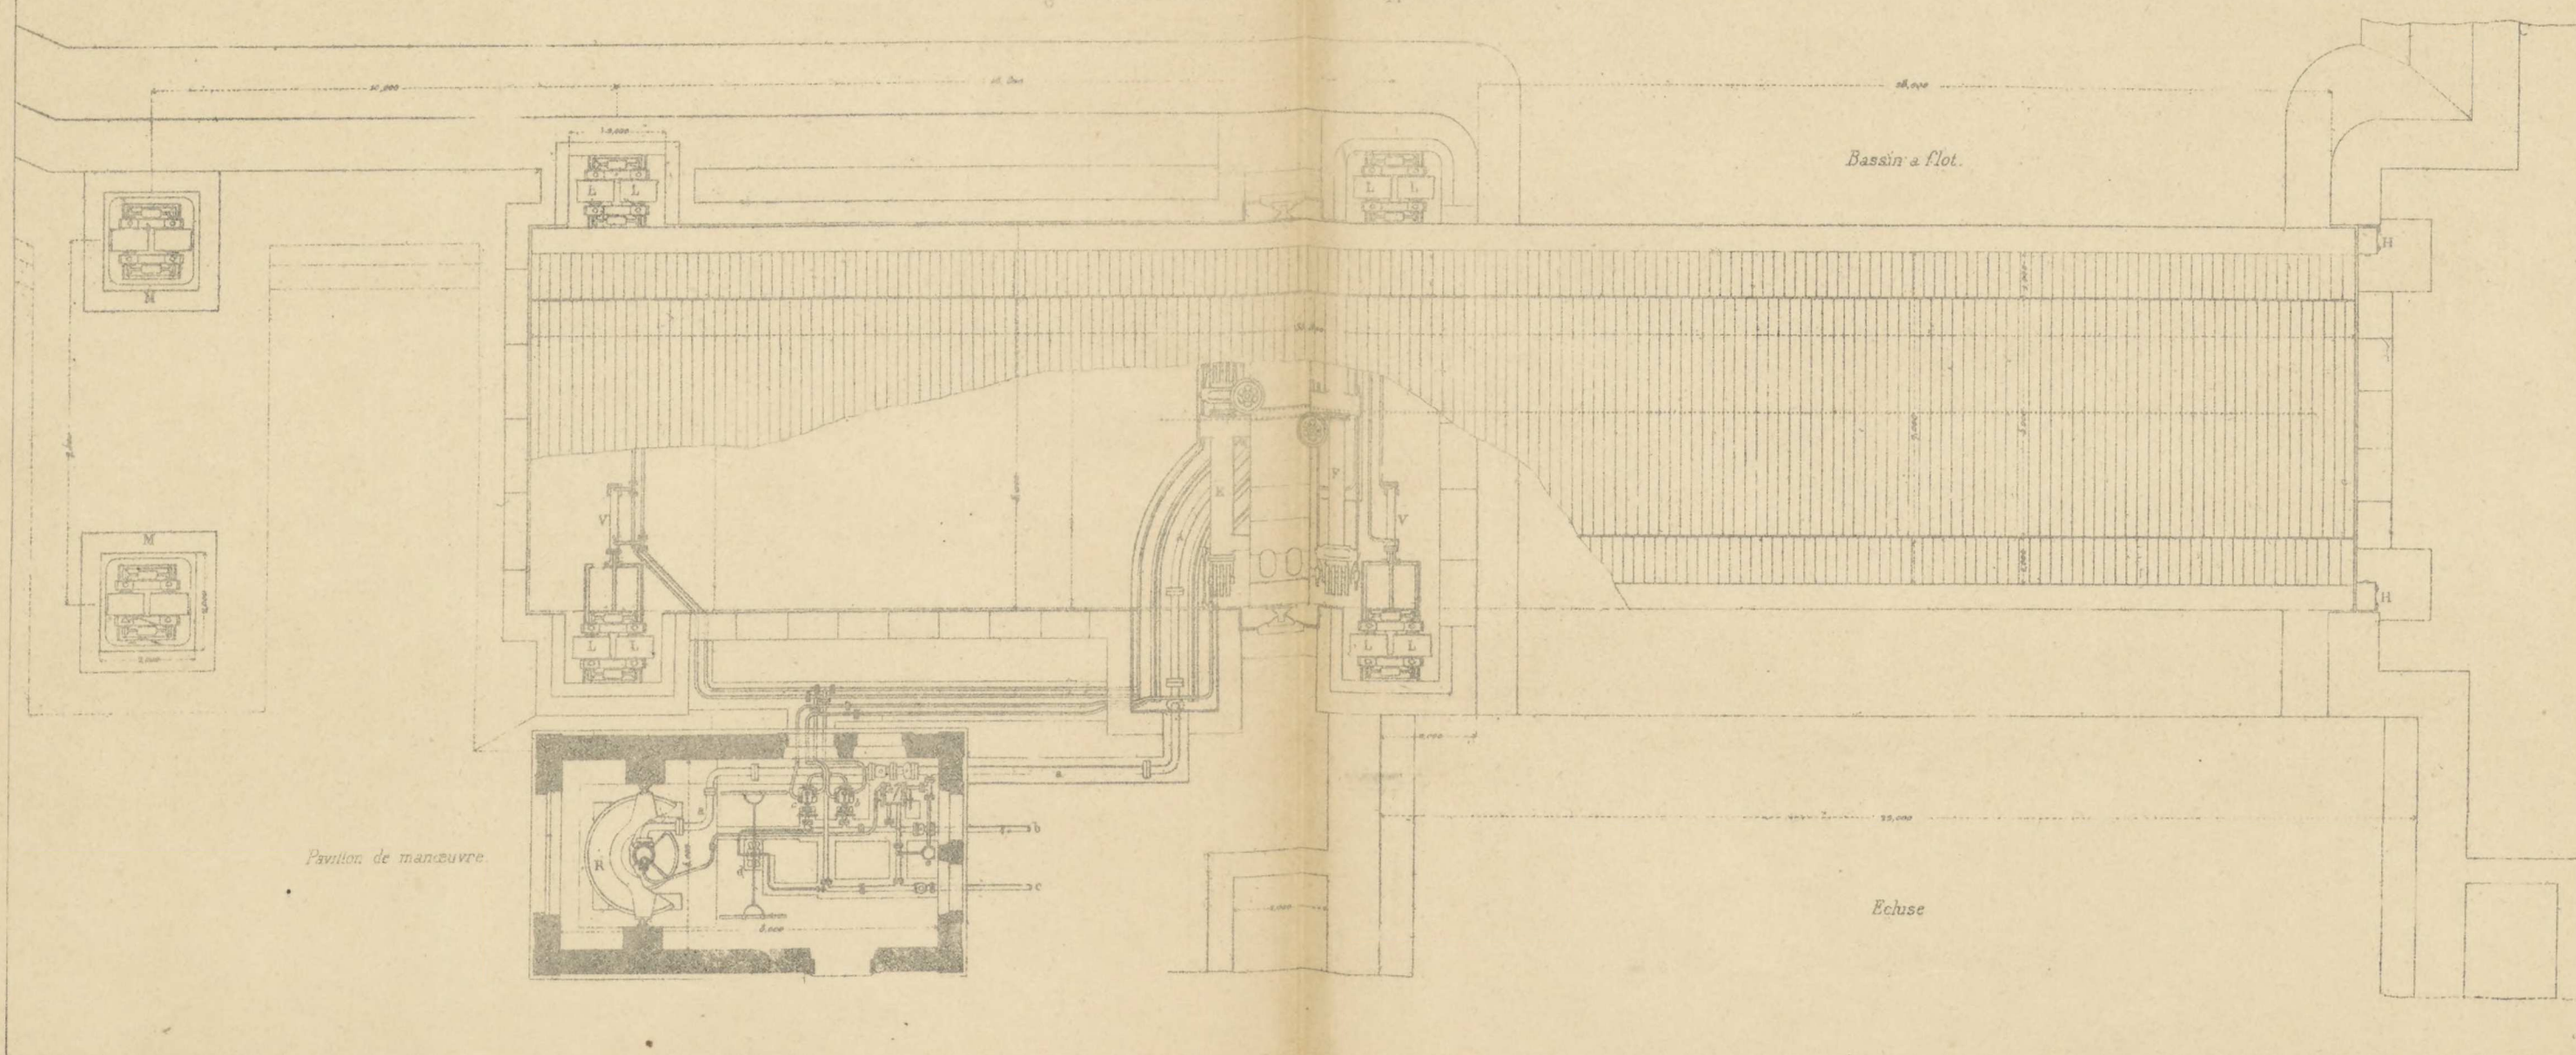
Plan avec arrachement montrant les appareils de manœuvre
